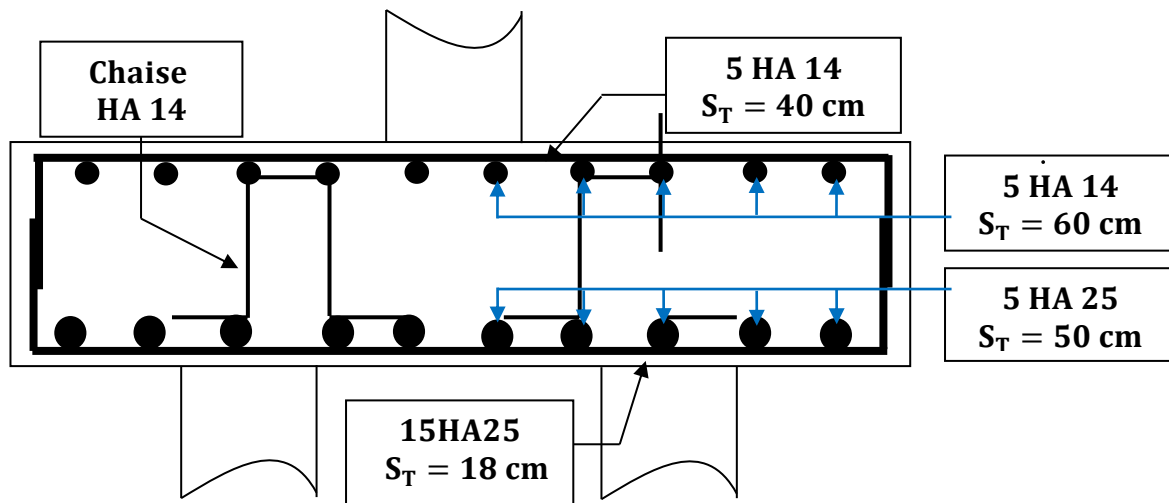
Ferrailage de la semelle - Coupe transversale - .
